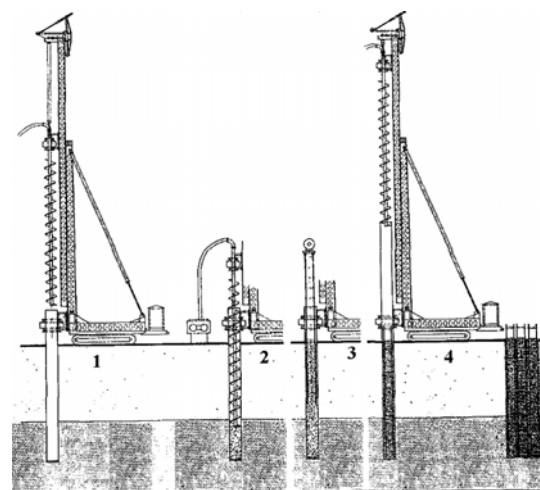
Технология свай DDM «Fundex»: 1 – погружение обсадных труб через слои слабых грунтов до плотных грунтов основания; 2 – извлечение грунта из обсадных труб; 3, 4 – бетонирование ствола, извлечение обсадных труб
